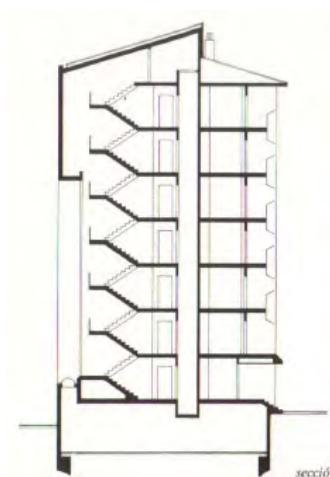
Secció transversal, edifici al c/Alcalde Moix, Sabadell. Aparcament en planta semisoterrani.
